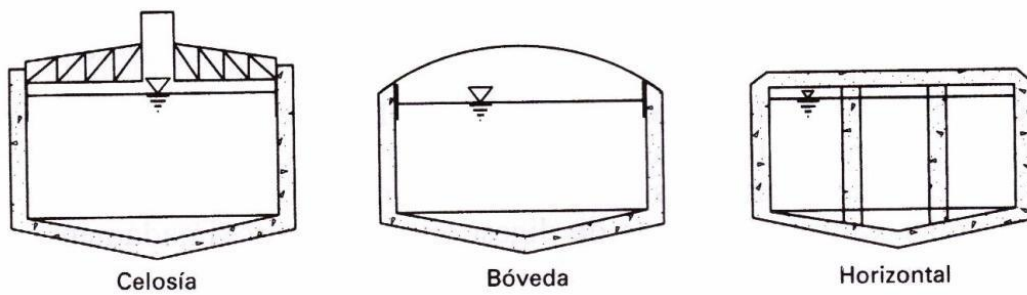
Cubiertas fijas para la recogida del biogás (Metcalf y Eddy, 1996).
